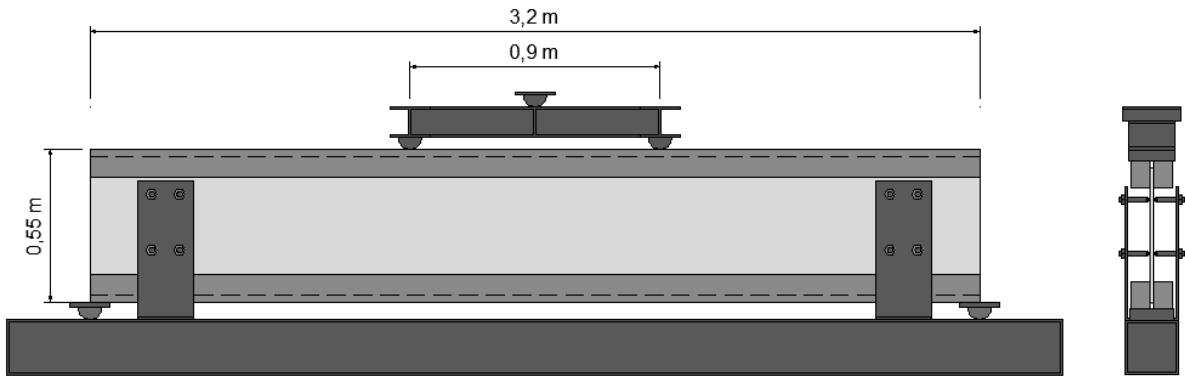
Esquema, longitudinal e transversal, de ensaio com duas cargas pontuais.
